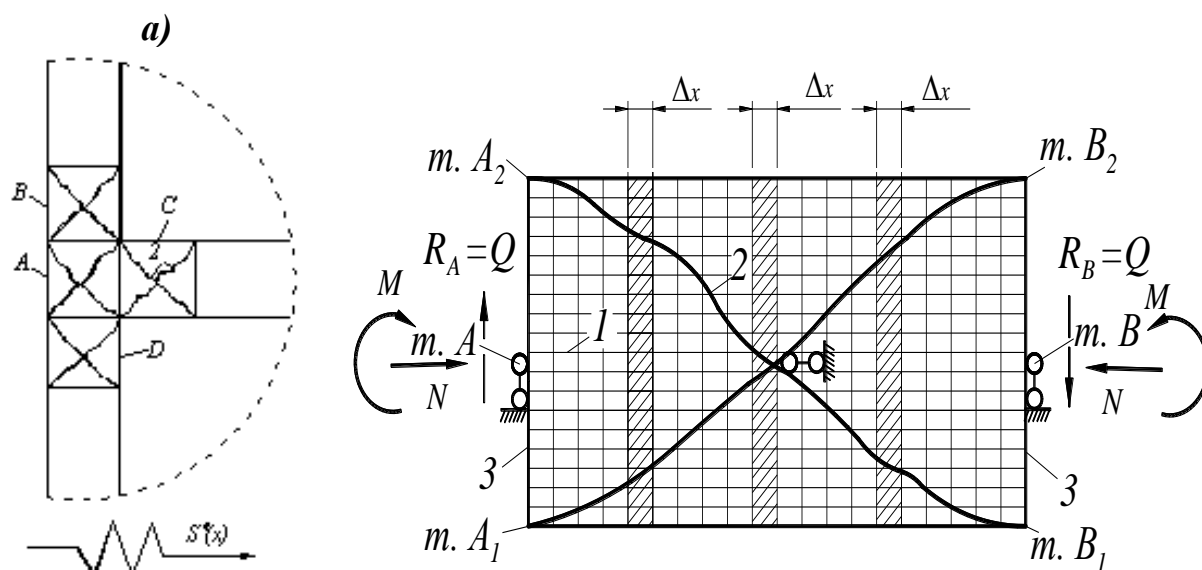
К расчету стержневых железобетонных конструкций в узловых зонах и на участках с наклонными трещинами на статические и сейсмические воздействия: а – выделение характерных зон и схем трещин; б – расчетная модель для уточнения жесткости выделенных зон; 1 – горизонтальные границы конечных элементов; 2 – трещины; 3 – абсолютно жесткие торцевые вставки
